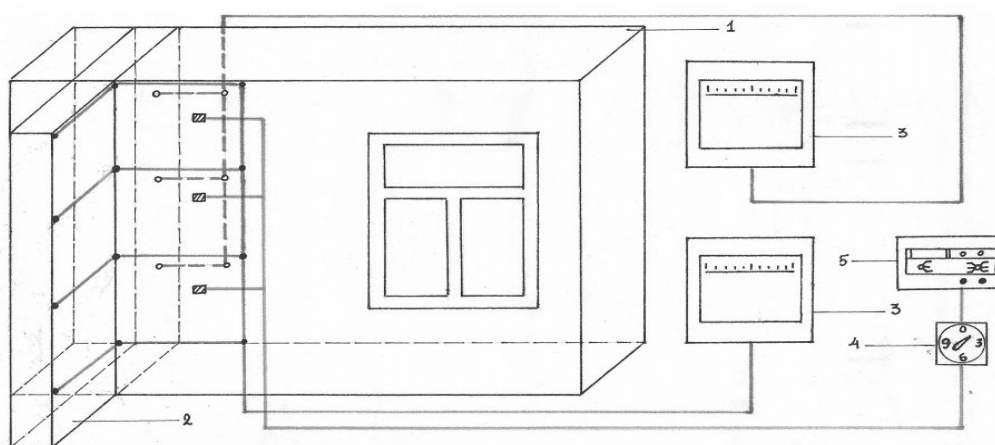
Схема размещения термодатчиков на поверхностях ограждений при определении теплозащитных качеств зданий. ● - термодатчики на внутренней поверхности стены; ○ – термодатчики на наружной поверхности стены; 1 – наружная стена; 2 – внутренняя перегородка 3 – потенциометр КПП; 4 – переключатель МГМ-10 М
